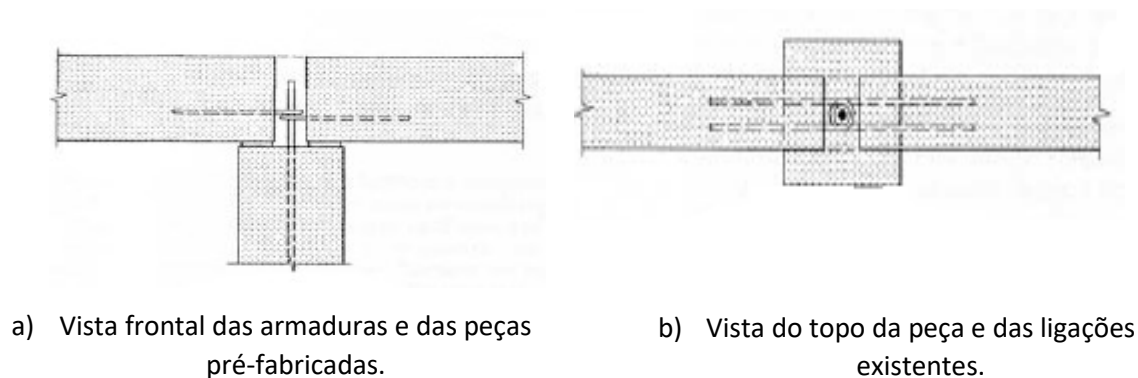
Ligação pilar – viga com recurso a armaduras de gancho (STUPRÉ, 1981).
